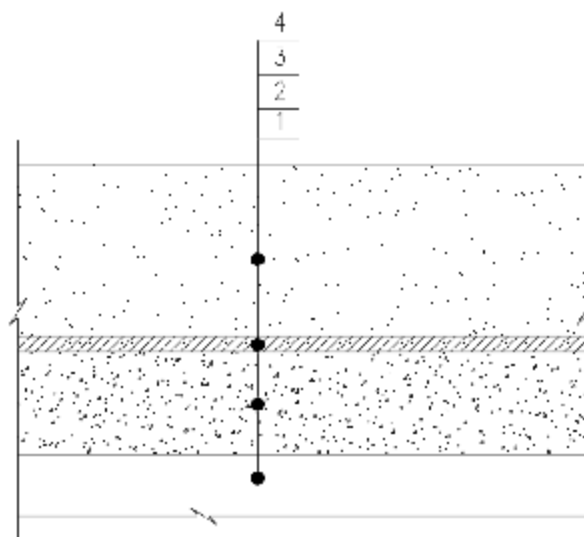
混凝土桥面板采用防水卷材防水层结构示意图
